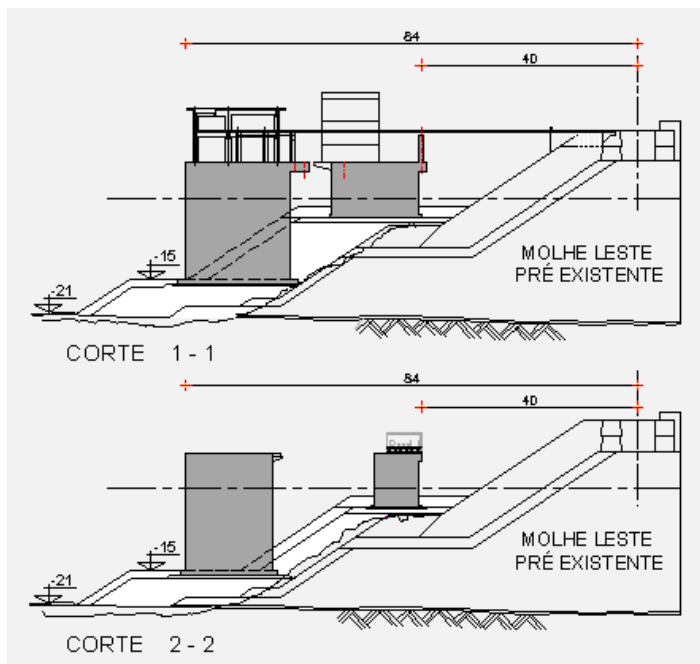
Cortes transversais. Corte 1-1 e Corte 2-2
